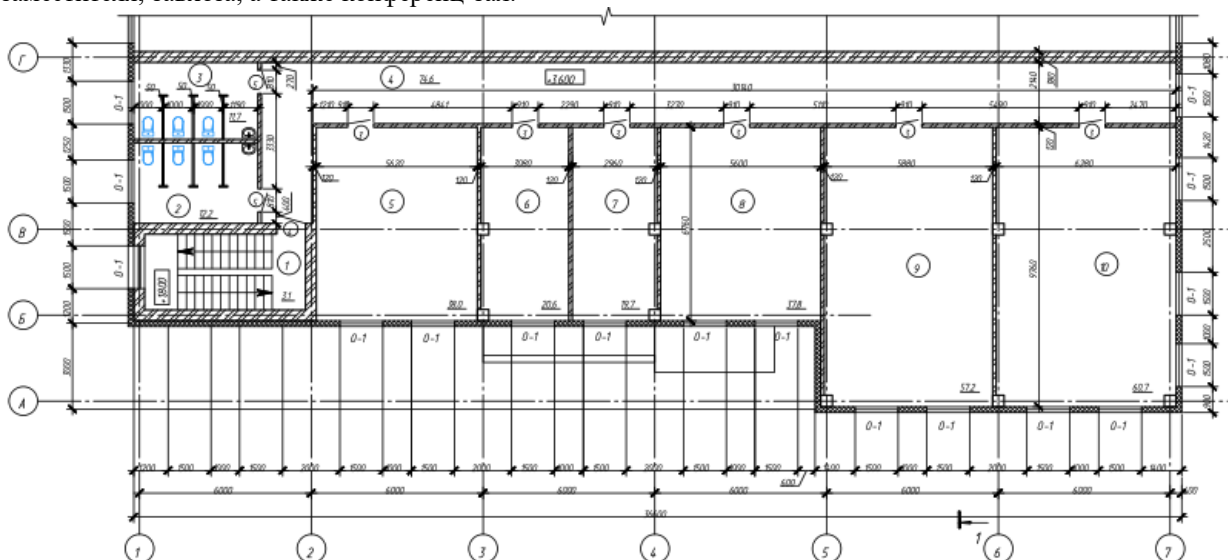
Фрагмент плана на отм. +3,600 (1:100)
